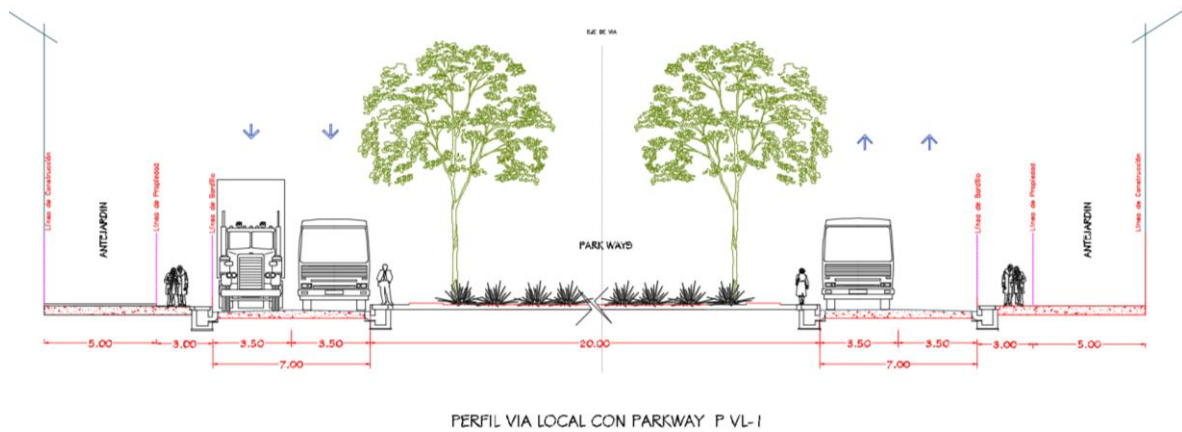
Planta y perfil vial típico Propuesta (PVL 1 VIA PARKWAY)
